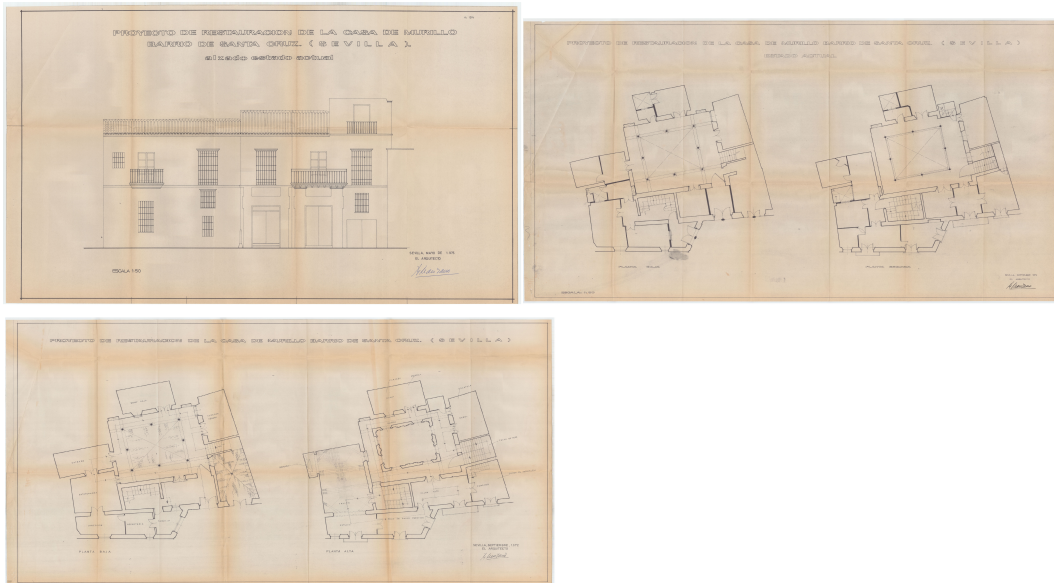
Fachada de la Casa Museo de Murillo y planos de la vivienda en estado previo y de proyecto de la restauración. Septiembre de 1972 y mayo de 1975. (AGA, MECD).
